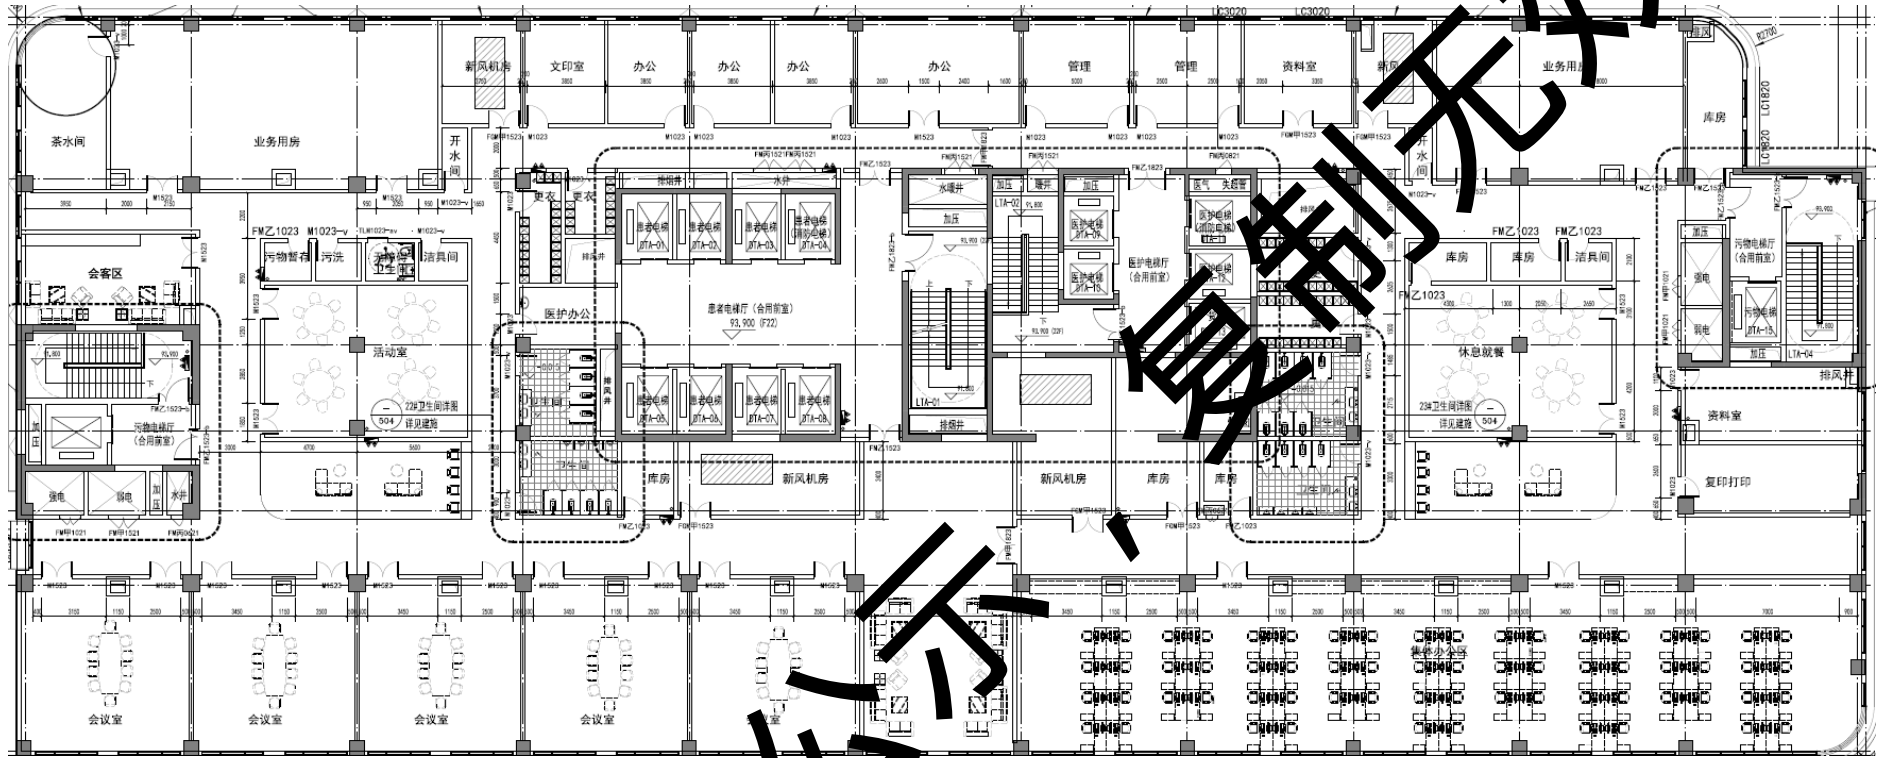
本项目新建住院综合楼 22F 平面布置图
